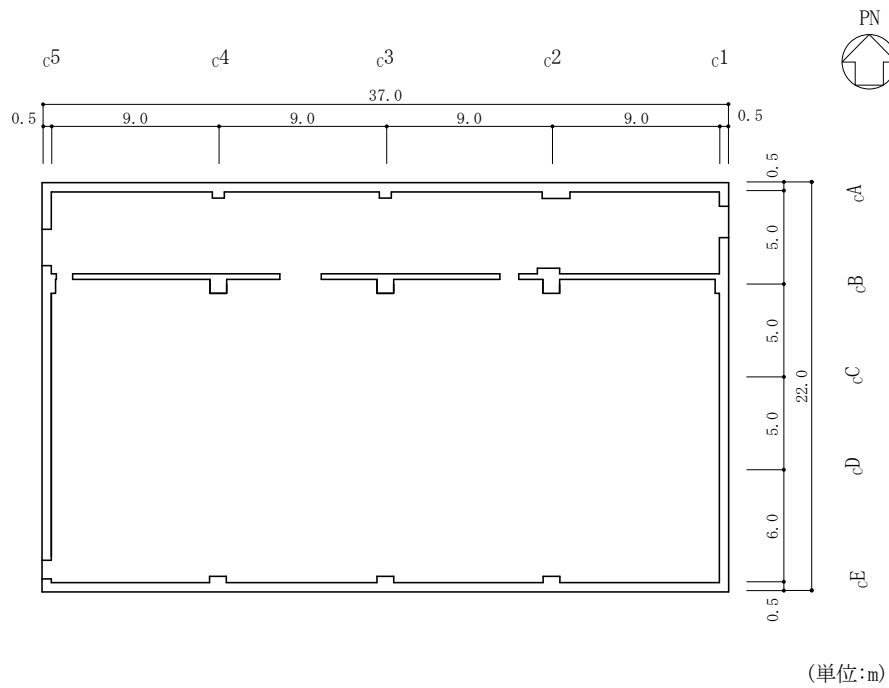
(4) 制御室建物の概略平面図 (EL 16.9m)
